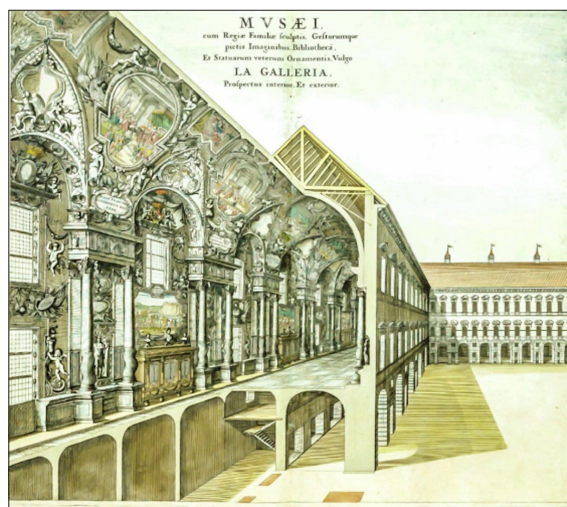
La Galleria di collegamento tra Palazzo Madama e Palazzo Reale, prima sede della Galleria Sabauda
